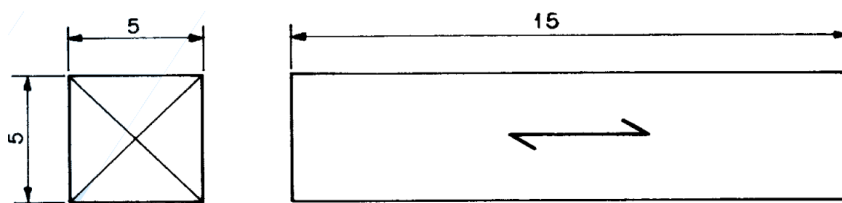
Dimensões do corpo-de-prova para ensaio de compressão paralela às fibras
